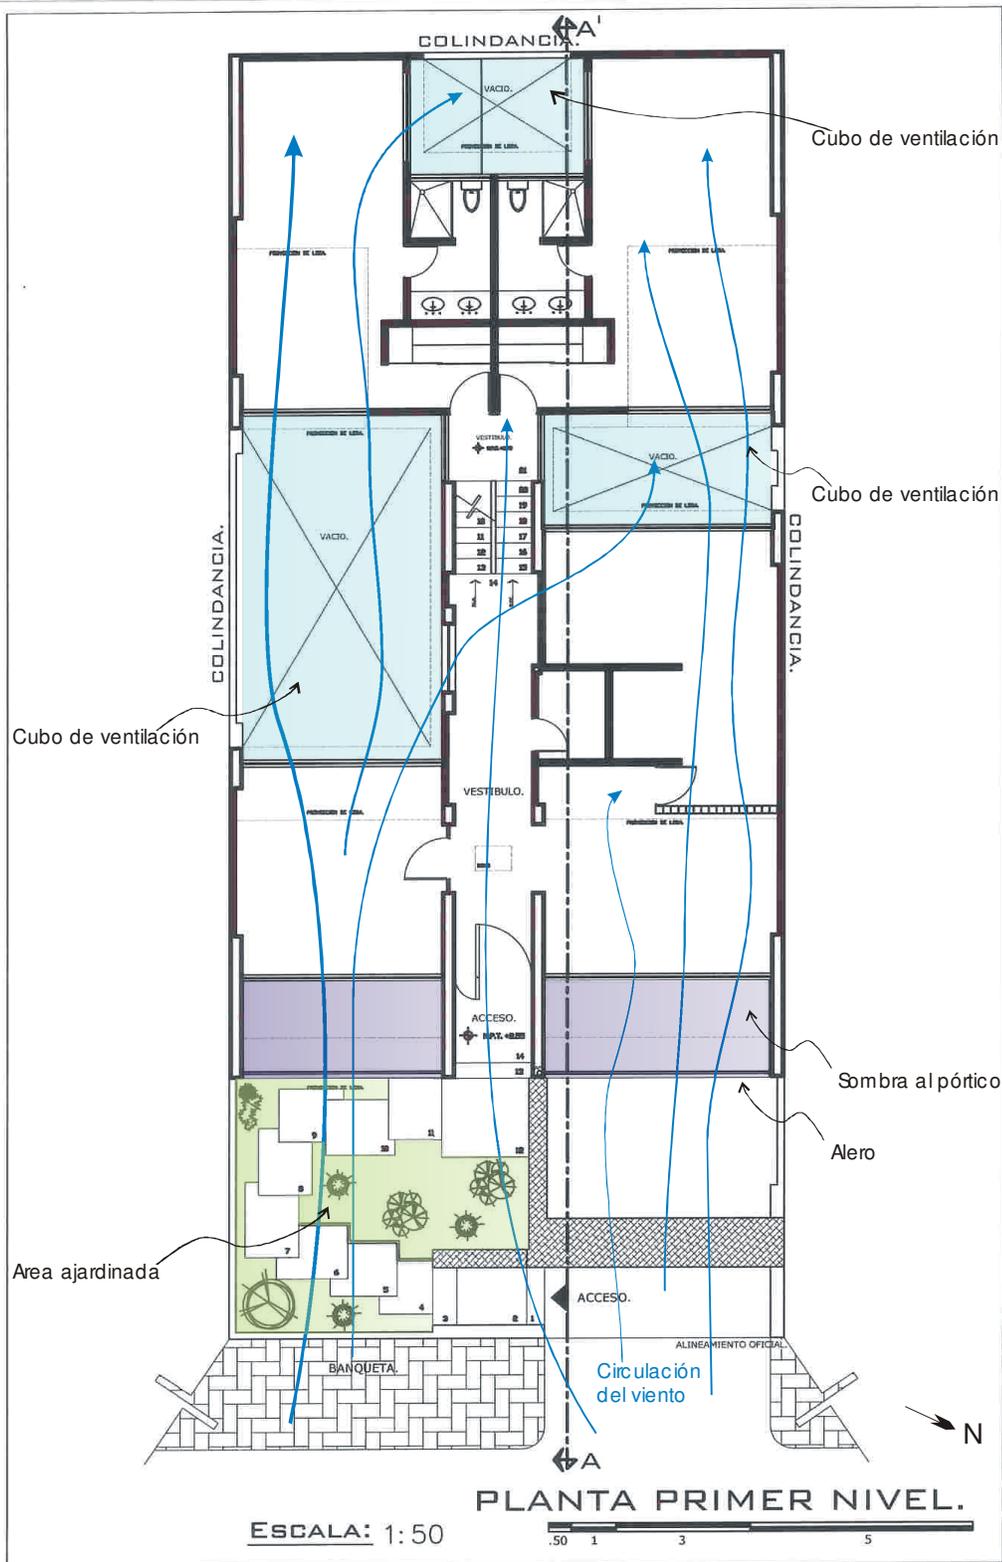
Análisis de la planta arquitectónica del primer nivel.
